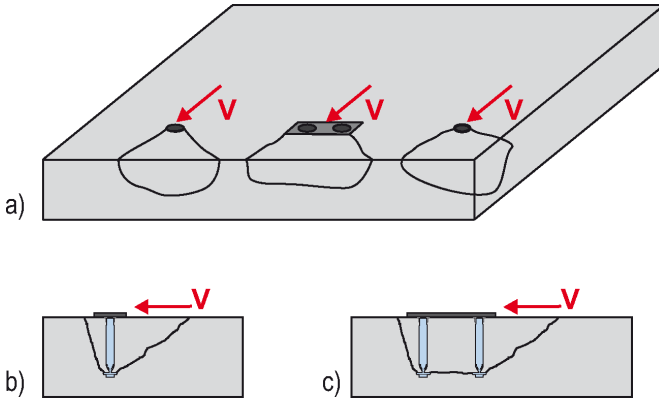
Betonkantenbruch (a) und rückwärtiger Betonausbruch (b), (c)
